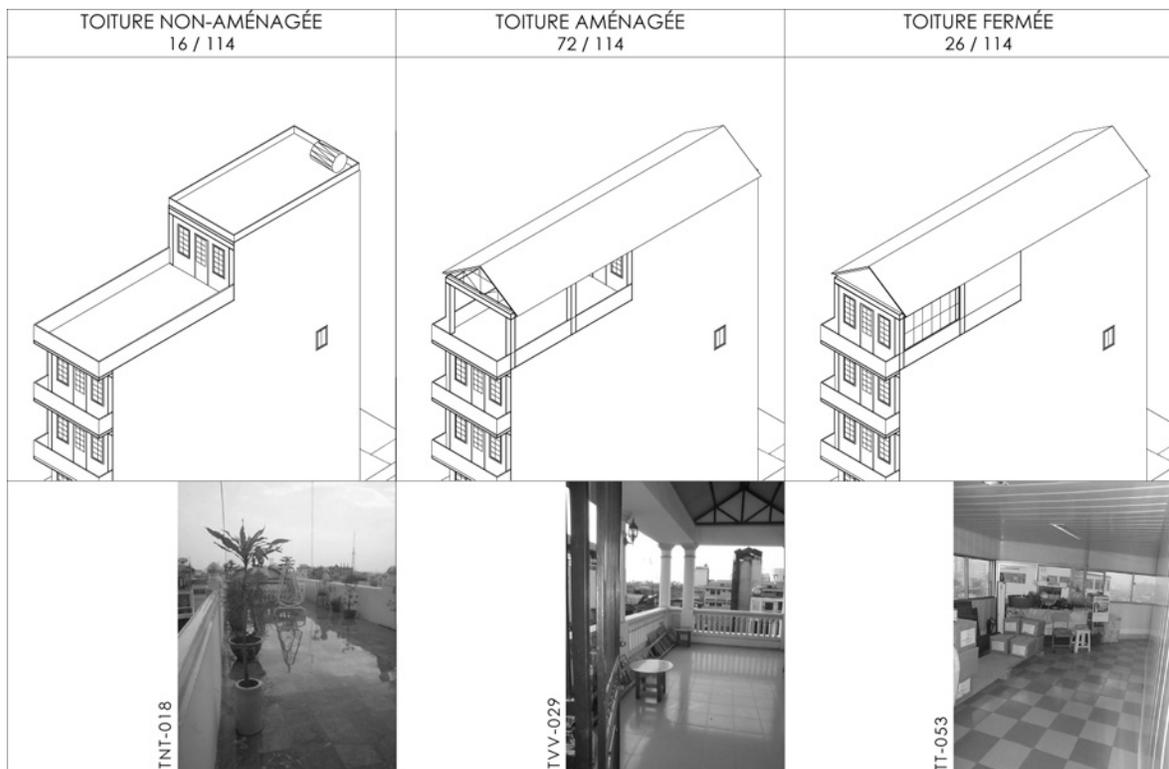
Trois exemples d'aménagement de toiture
